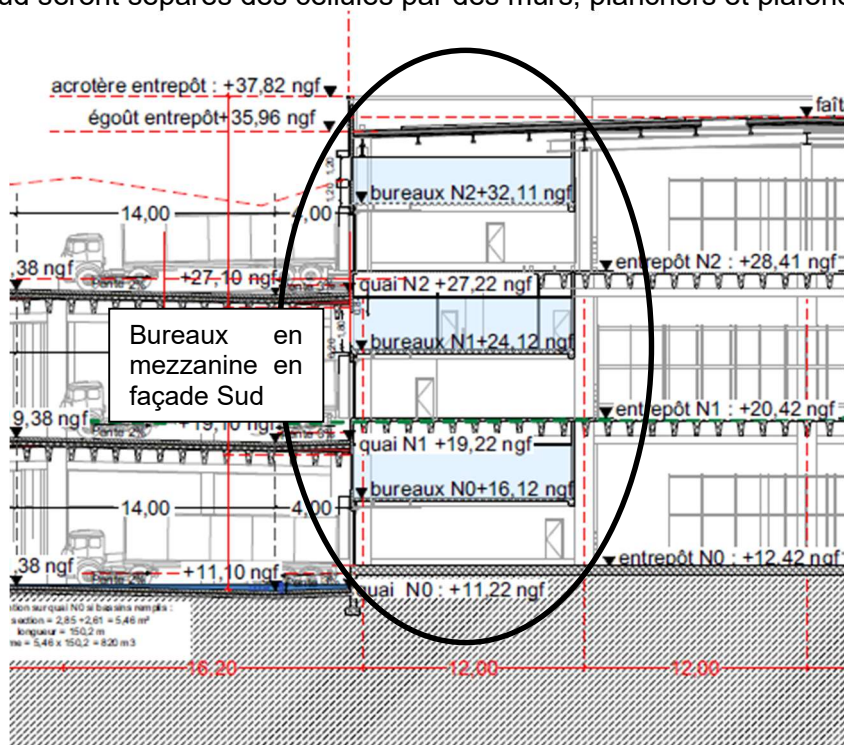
coupe bureaux mezzanine de l'entrepôt
